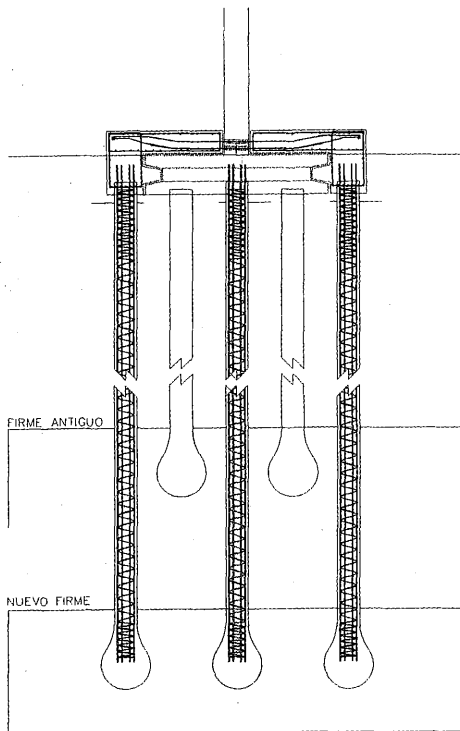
Recalce de una cimentación profunda (realizado en pilotes de hormigón armado) mediante un recalce profundo consistente en la ejecución de pilotes de hormigón armado con un nuevo encepado.
